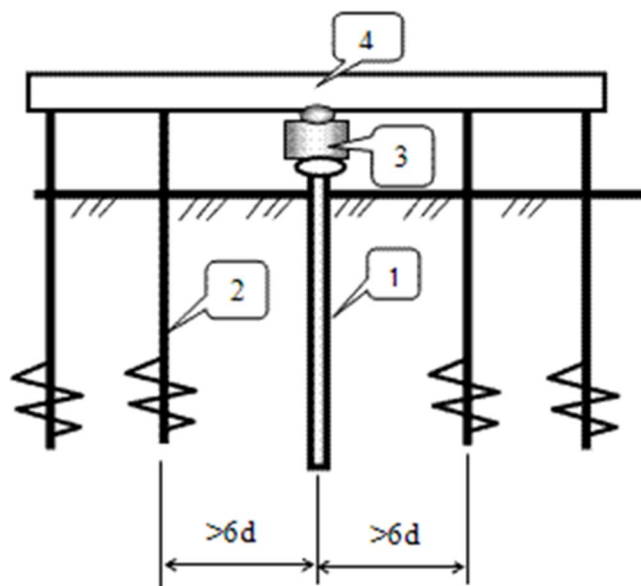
Схема установки оборудования при проведении испытаний свай статической нагрузкой.
